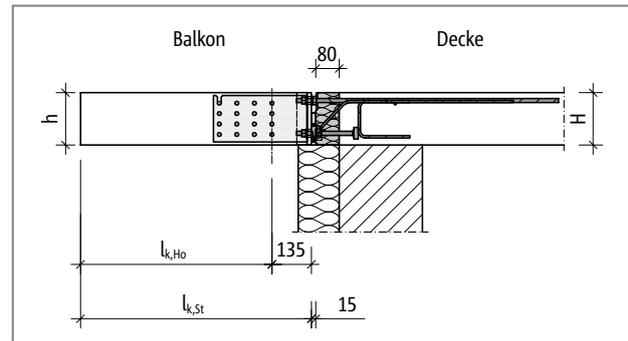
Schöck Isokorb® T Typ SK mit Stahlschwert: Statisches System
